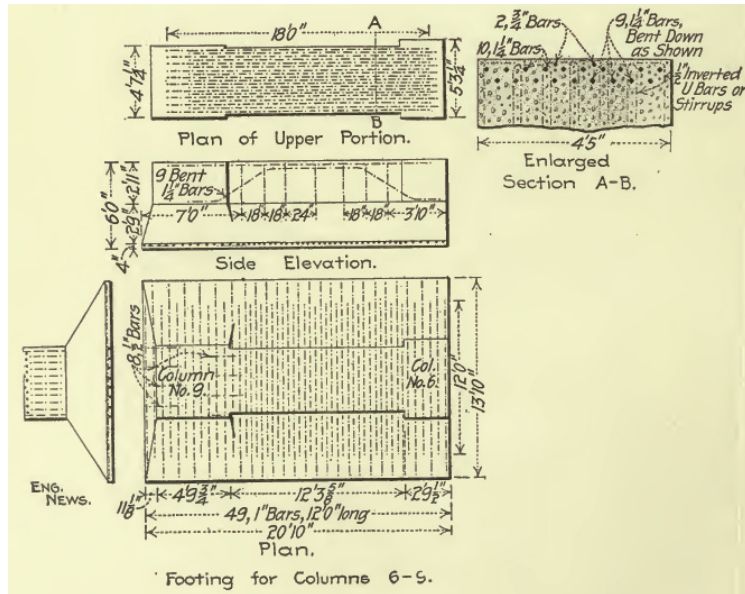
Zapata combinada de hormigón armado. Buel [3].
